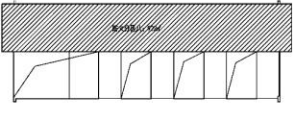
中航锂电专用变电站一层平面布置图 (mm)
